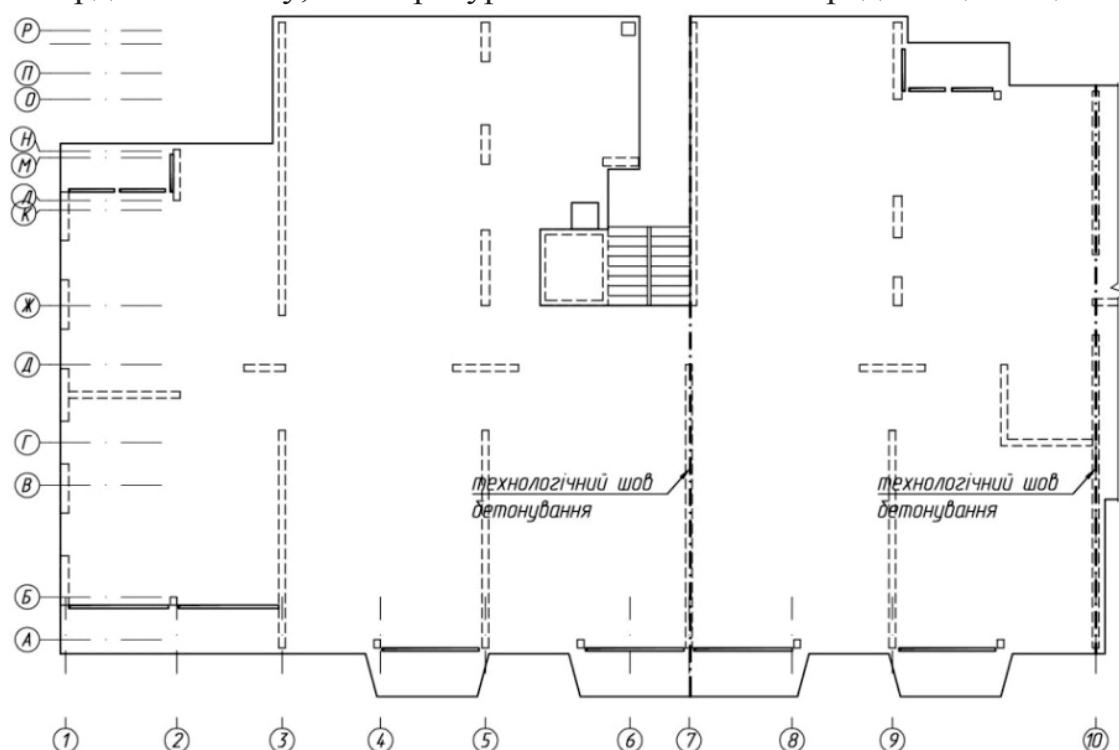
Розбивка на захватки при бетонуванні перекриття типового поверху будинку №3 по вул. Білогірській у м. Тернополі
